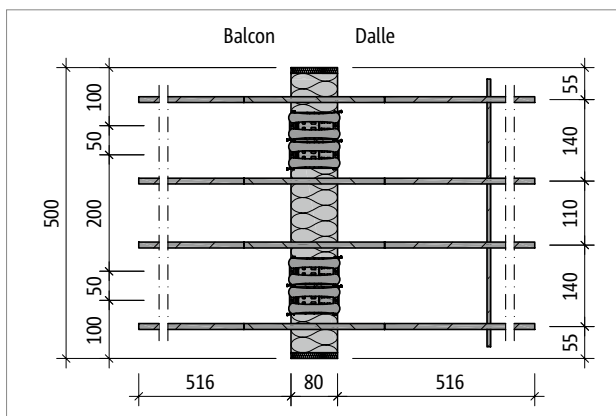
Schöck Isokorb® T Type Q-E-V5-L500 : Plan de base du produit
